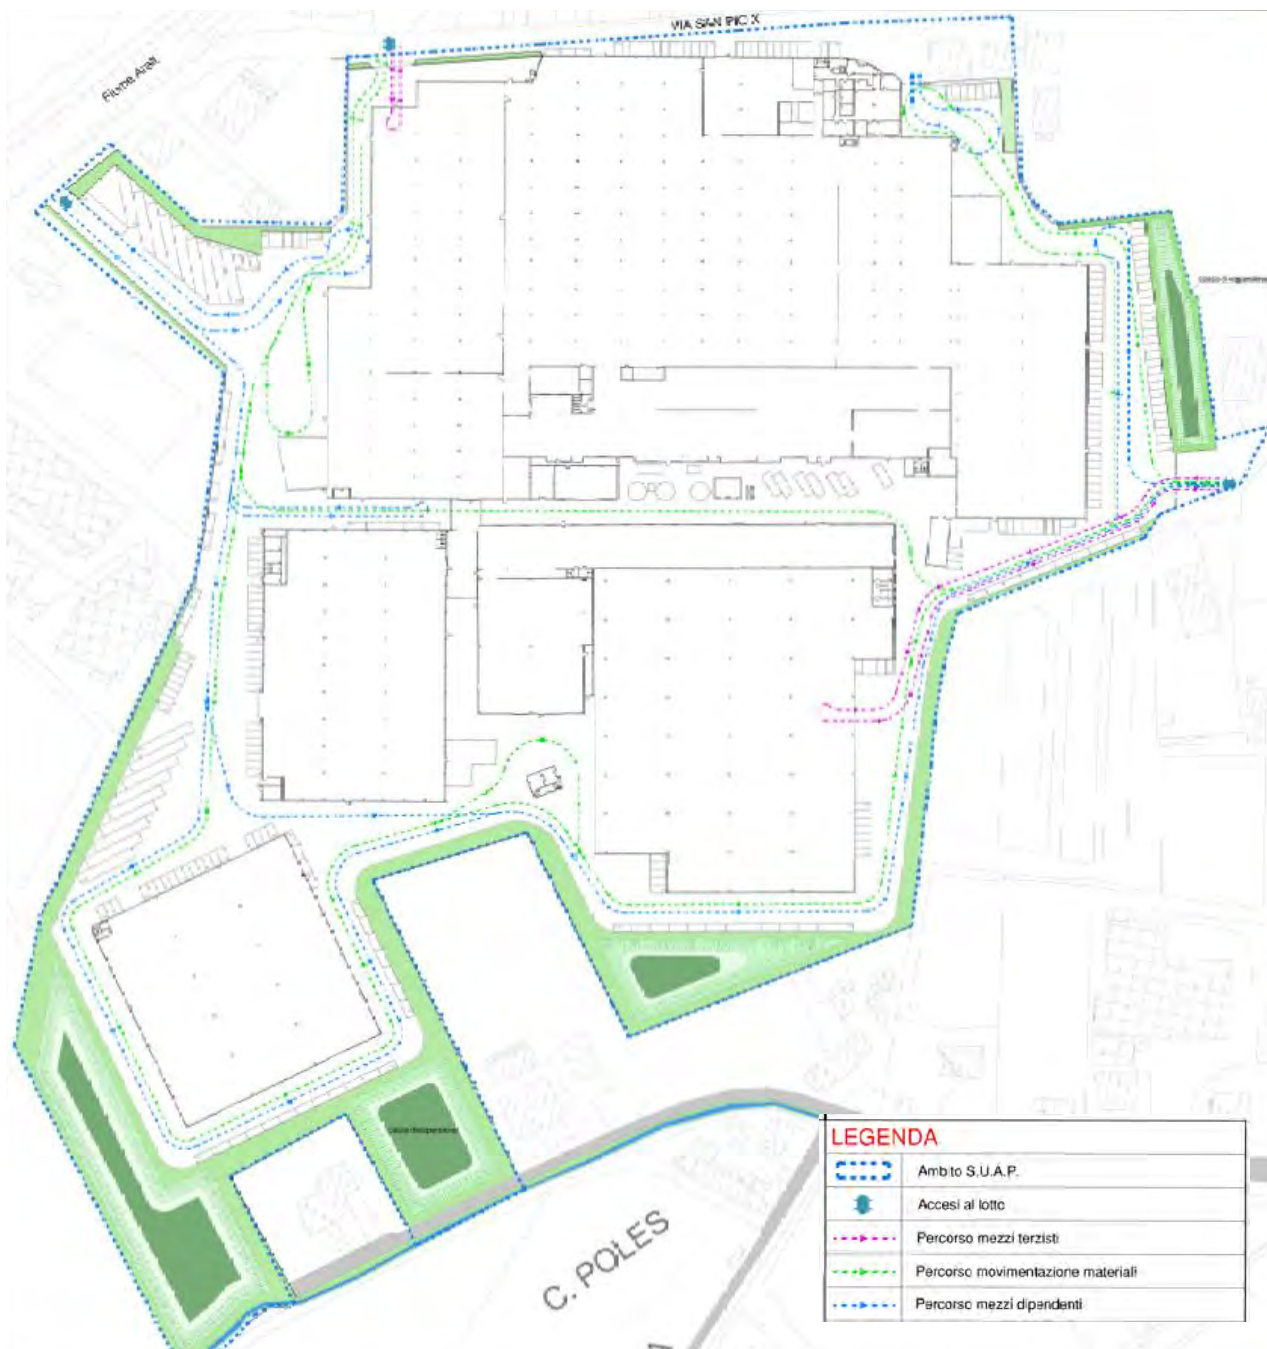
Estratto Planimetria viabilità interna di PROGETTO – TAV A-023
